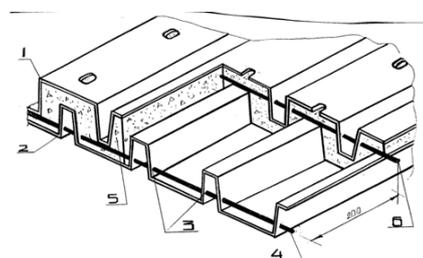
Сталефибробетонная плита перекрытия с двойным профилированным настилом:
